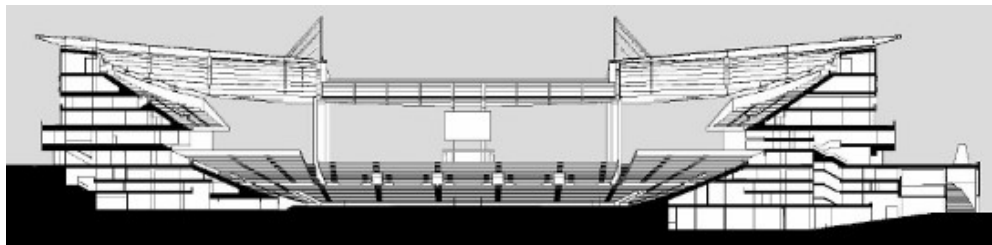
Estádio do Dragão, corte Poente – Nascente (adaptado de Marques, 2009).
